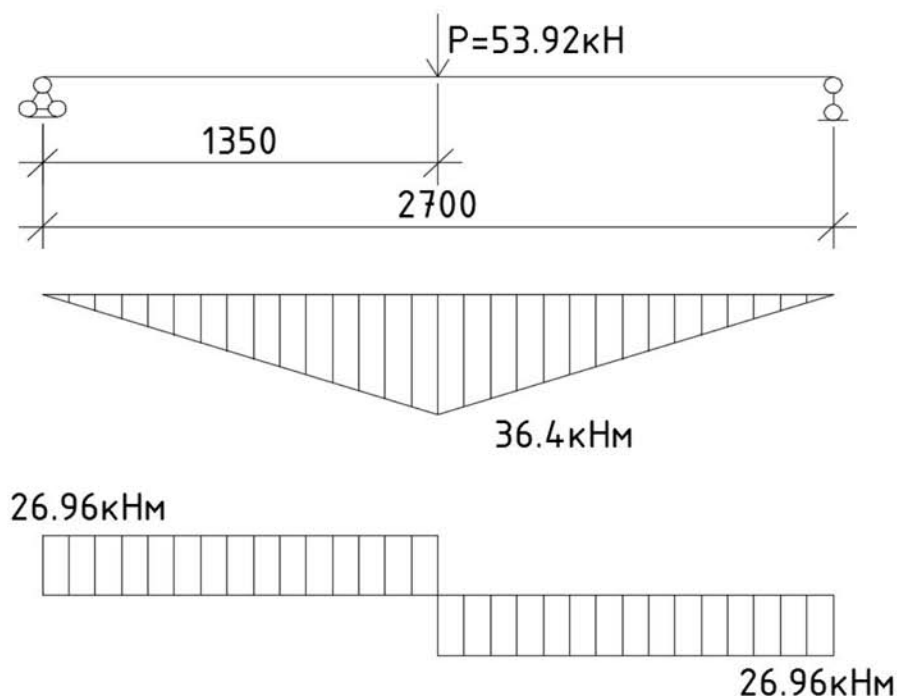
Расчетная схема, эпюры момента и поперечной силы усиленной балки Б2
